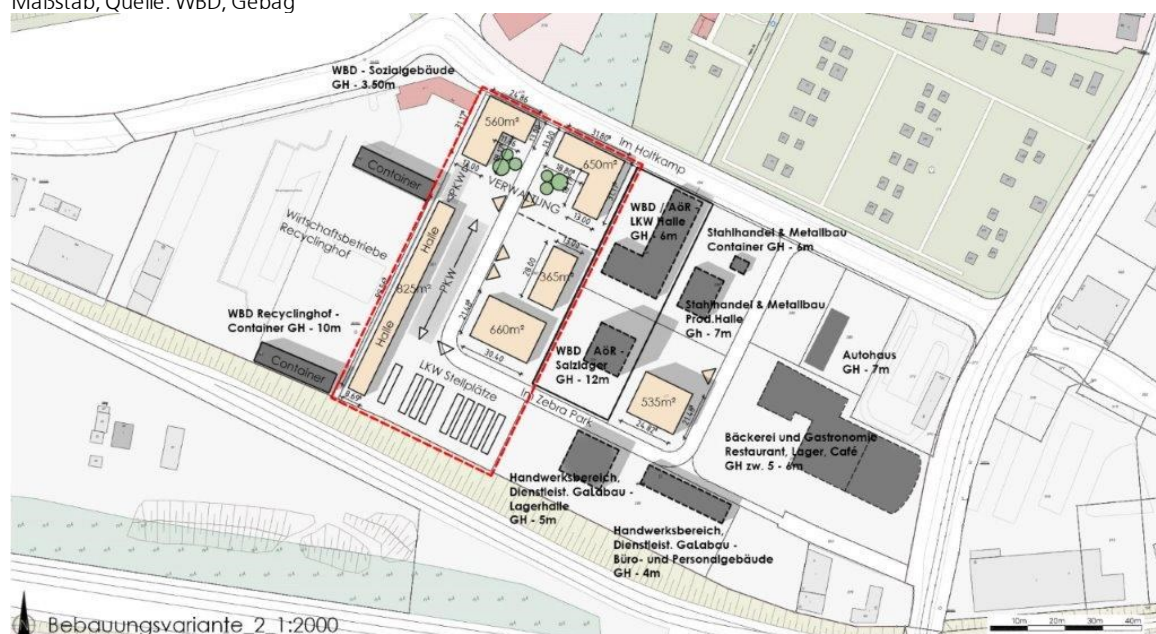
Bebauungsvariante 2, Städtebauliches Konzept der Teilaufhebung Nr. 1276 -Röttgersbach- „Im ZebraPark“, ohne Maßstab; Quelle: WBD, Gebag
